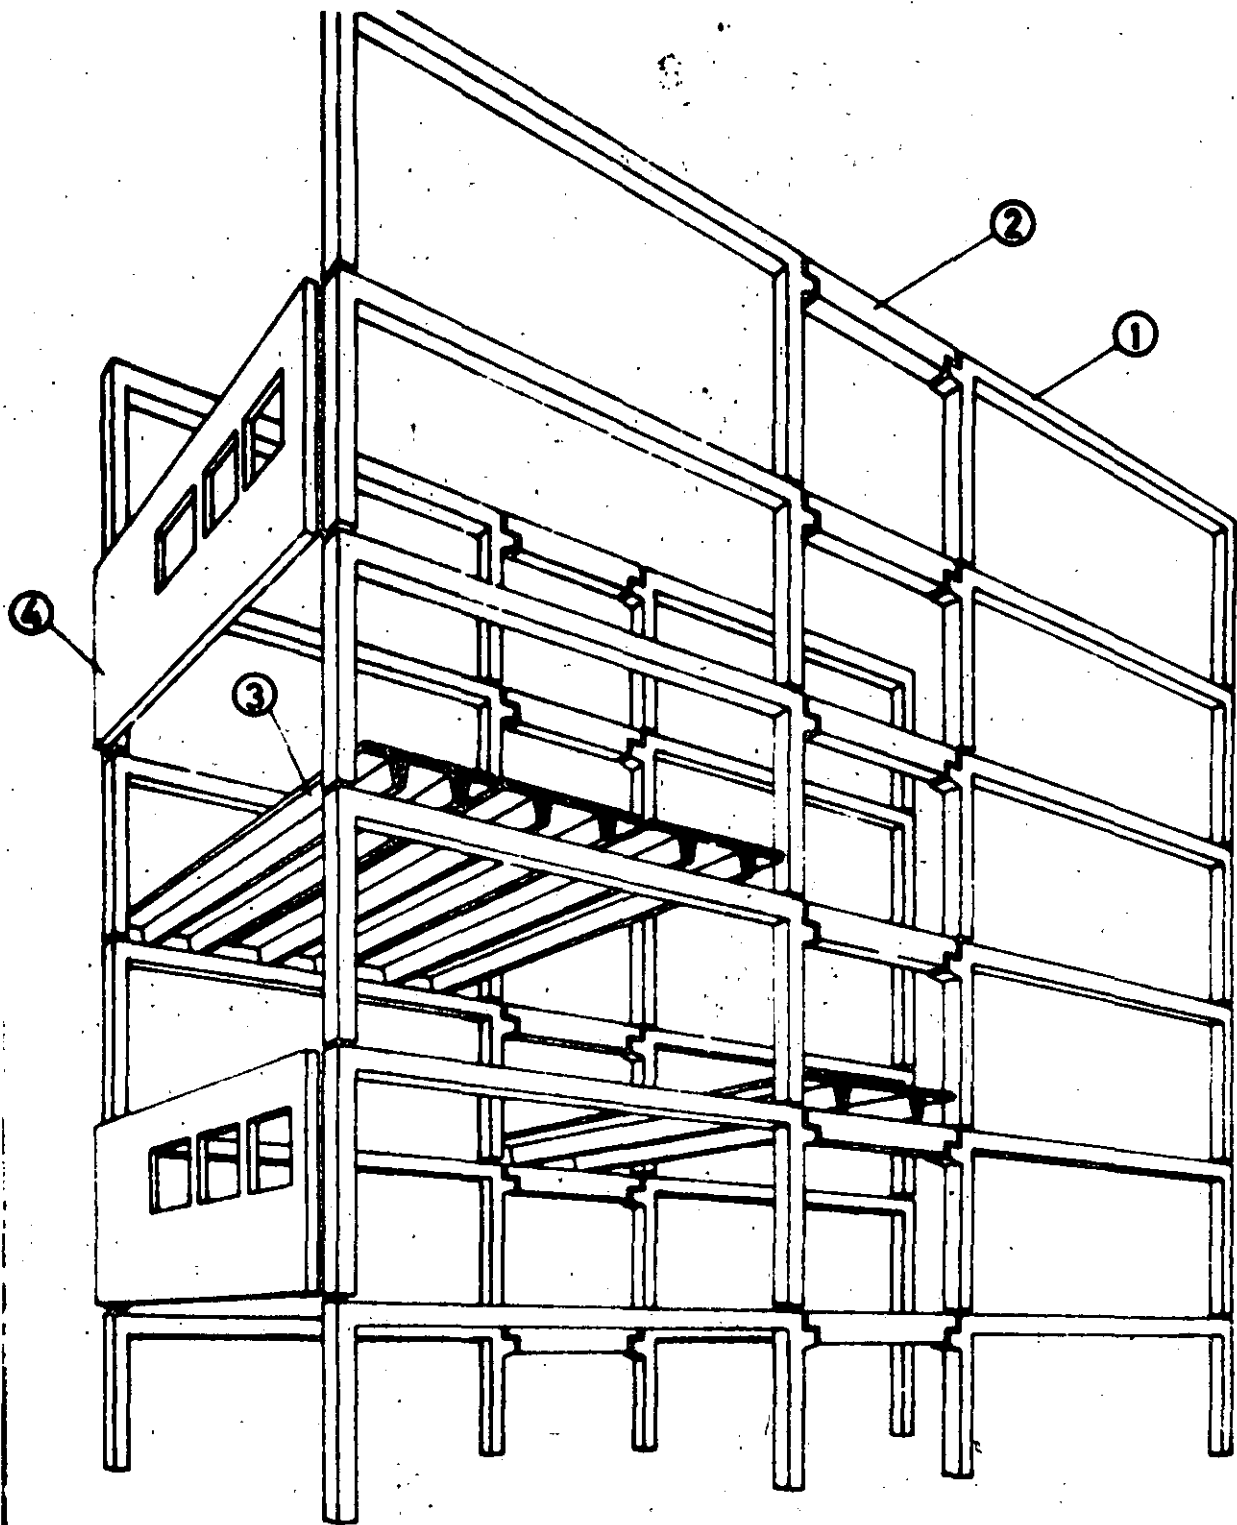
Pórticos biarticulados, 1; con vigas suspendidas, 2; elementos de forjado, 3, y paneles de fachada (por ejemplo, con las ventanas ya incorporadas en la fabricación).
